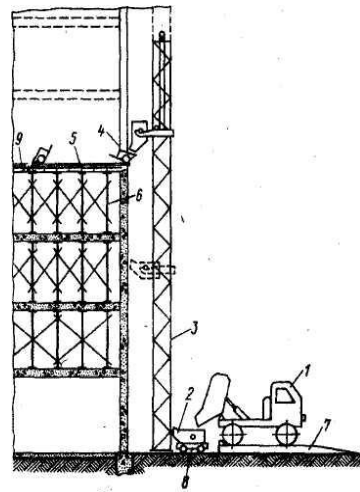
Подача бетонной смеси стоечным подъемником:
